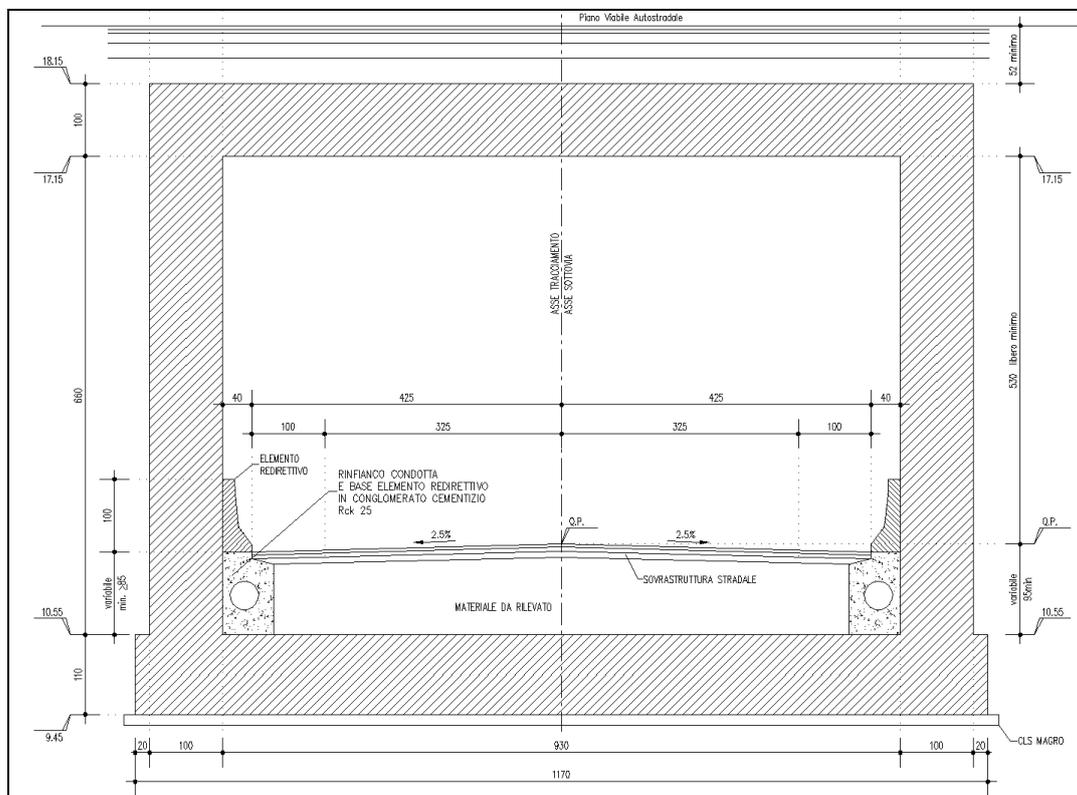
SEZIONE TRASVERSALE DEL SOTTOVIA
